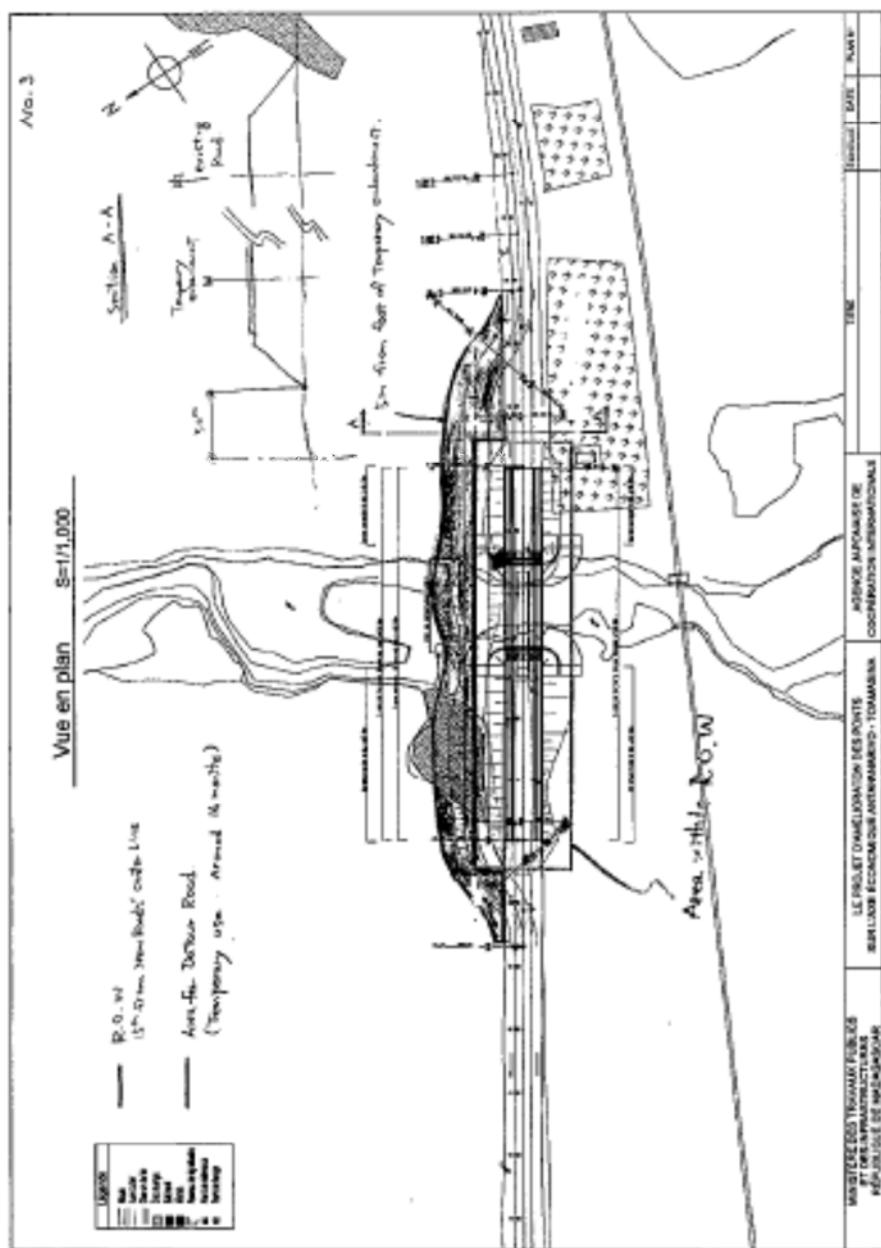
PLAN FINAL FOUR ANTSAPAZANA
